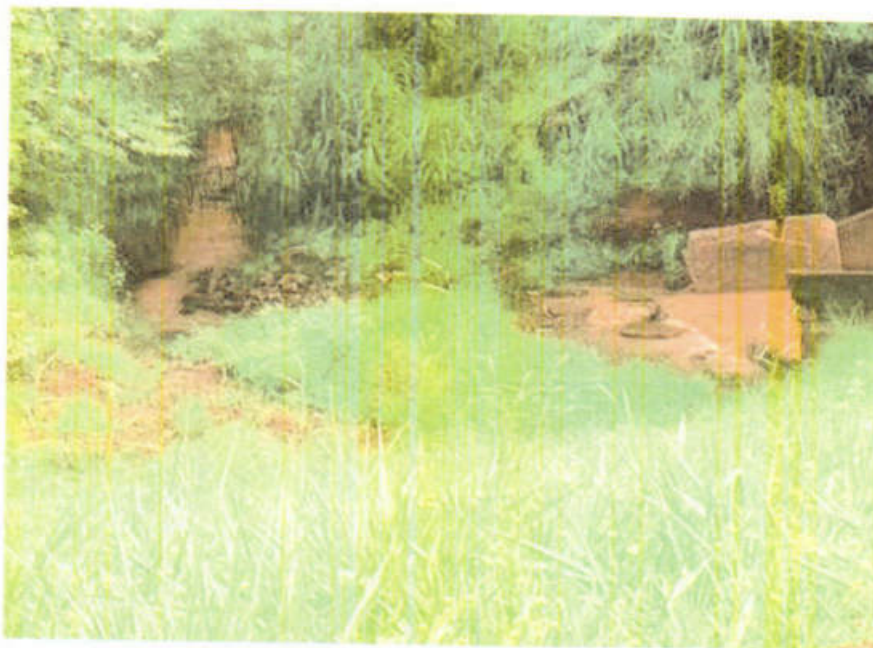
Entulho oriundo da destruição do vertedouro depositado no córrego.
